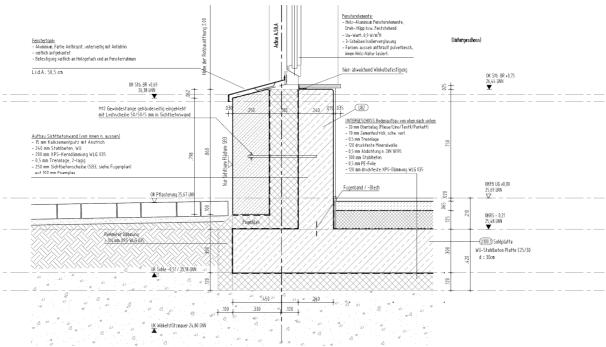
Fassadenschnitt - Fußpunkt Sockelgeschoss Betriebshof (IBUS Architekten)
